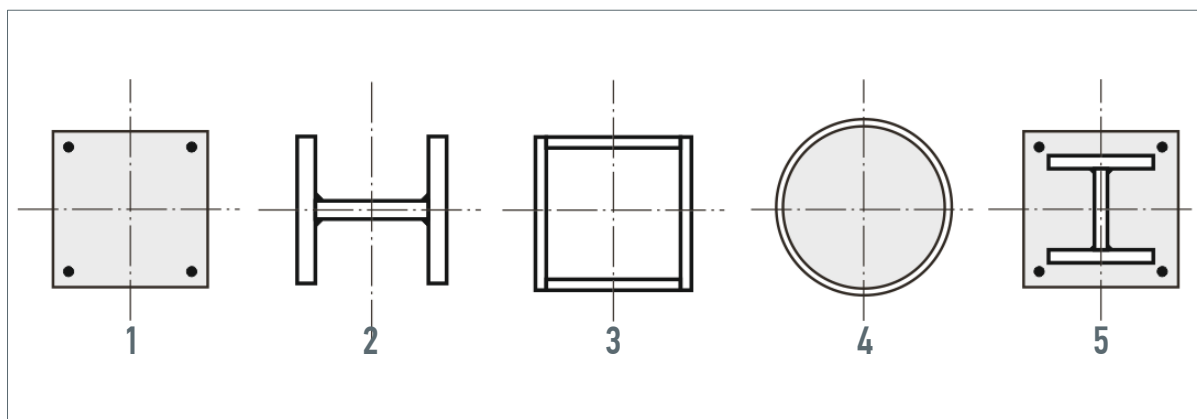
Перерізи колон багатопверхових автостоянок: 1 – збірні і монолітні залізобетонні; 2, 3 – сталеві; 4 – сталобетонні; 5 – сталезалізобетонні
